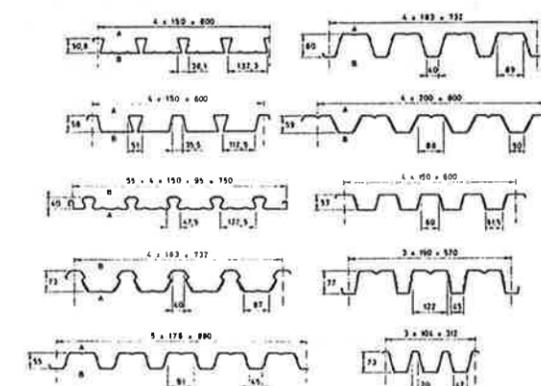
Tôles profilées utilisées pour les dalles mixtes
